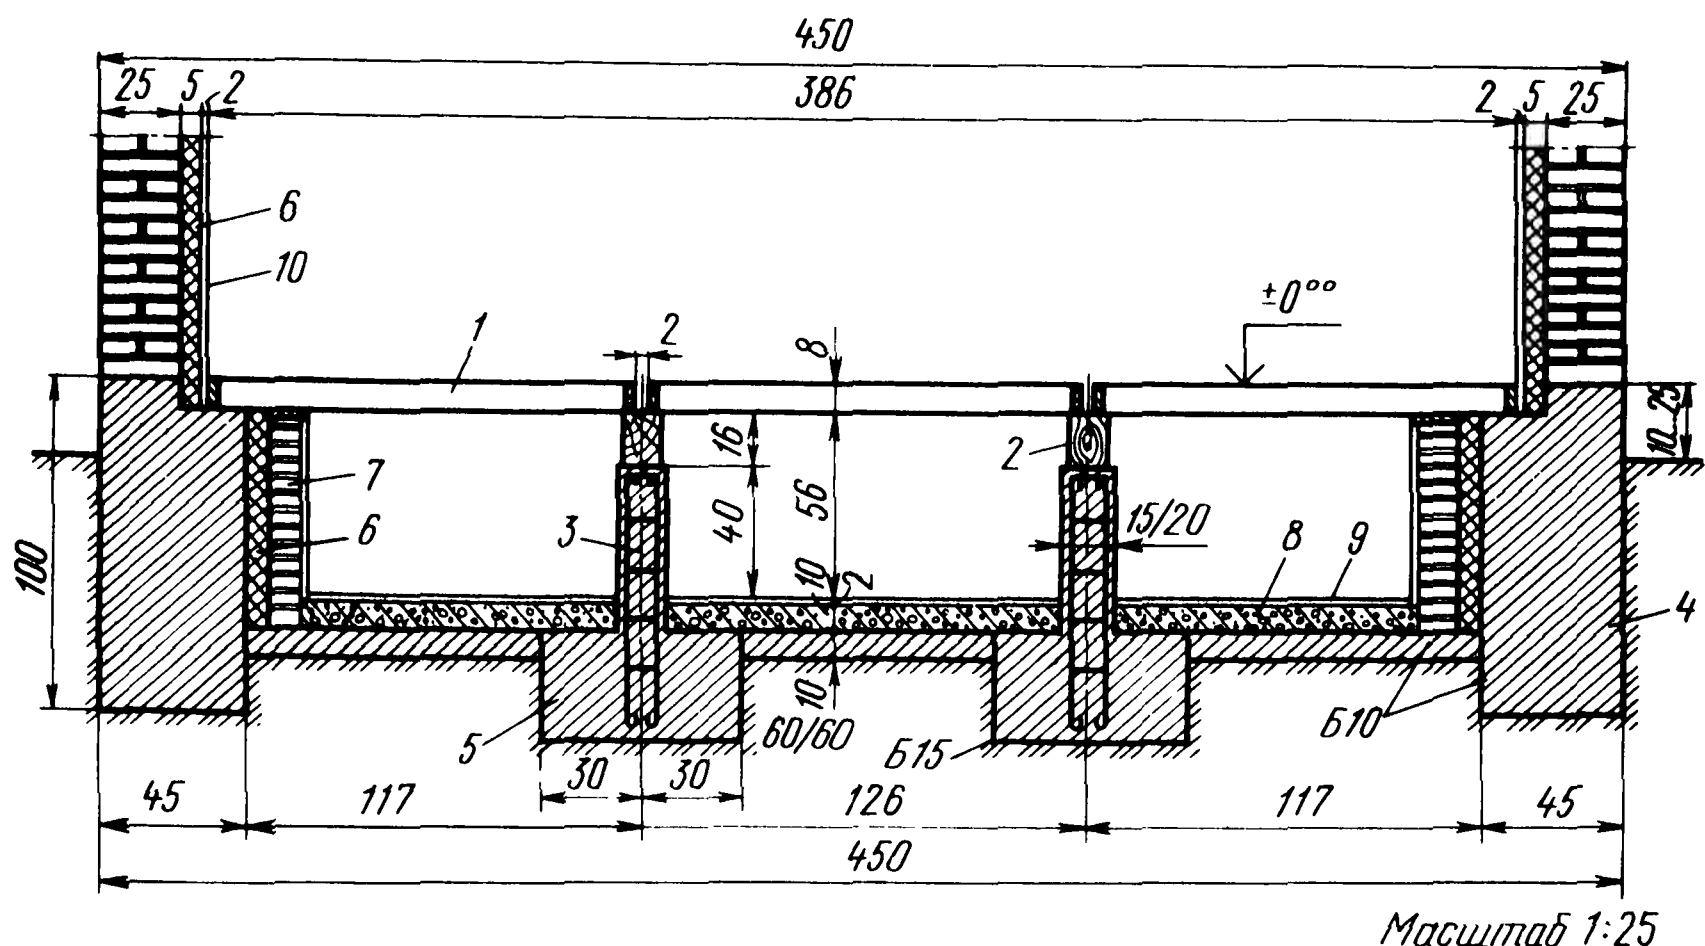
Поперечный разрез плана фундамента небольшой камеры:
